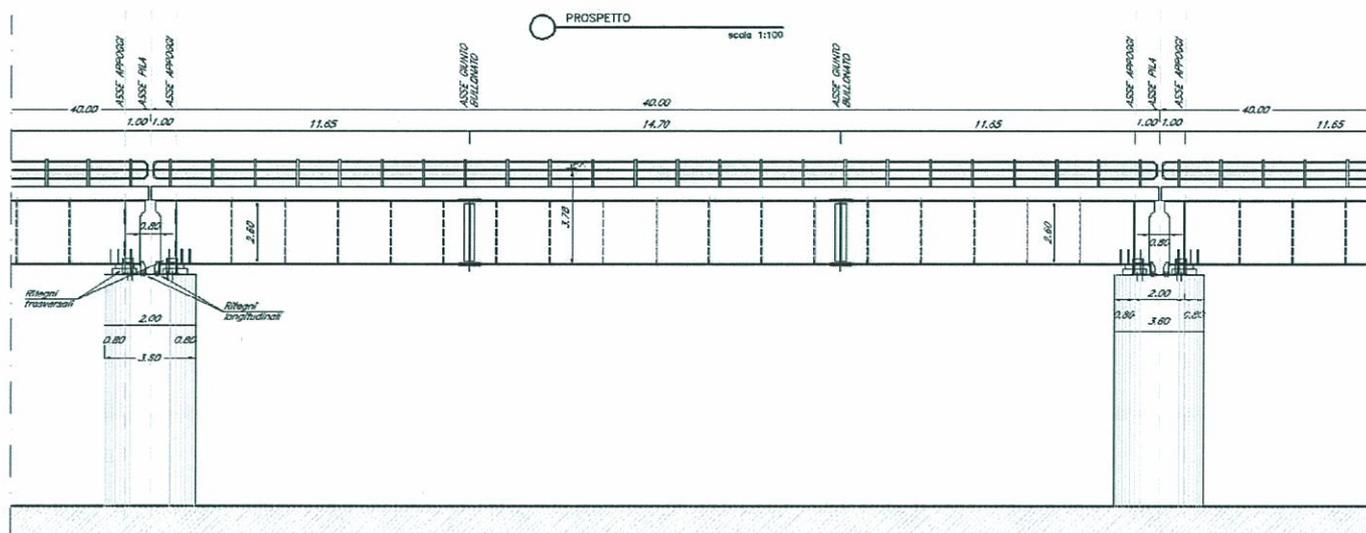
Prospetto impalcato a struttura mista acciaio/cls.
